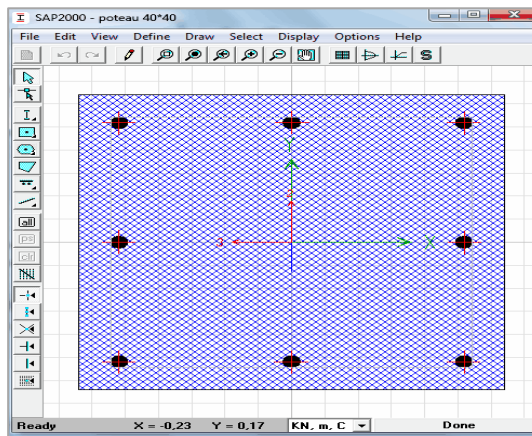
Dessin de ferrailage de poteau (40x40) sur SAP2000.
